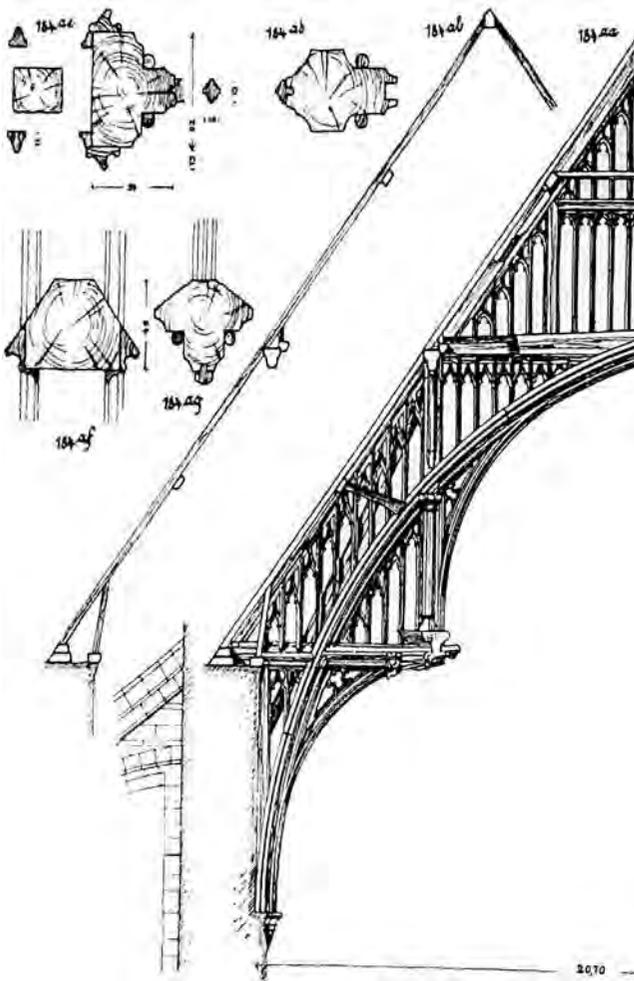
Palast Westminster in London, Dachwerk mit Kragbalken und drei Bögen, aus /31/
